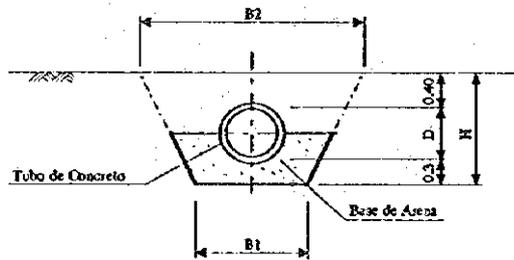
Obra de Alcantarillado del Camino (Tipo-I)
